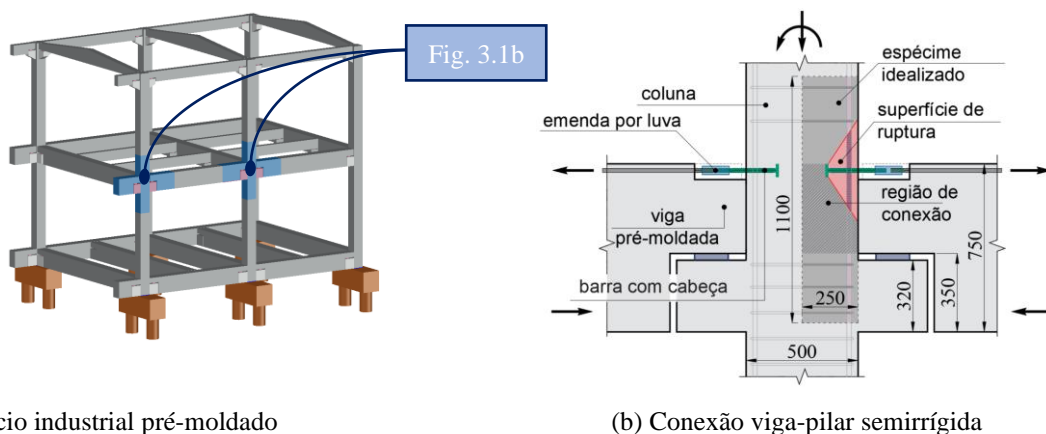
Barras com cabeça embutidas em elementos de concreto armado pré-moldados
